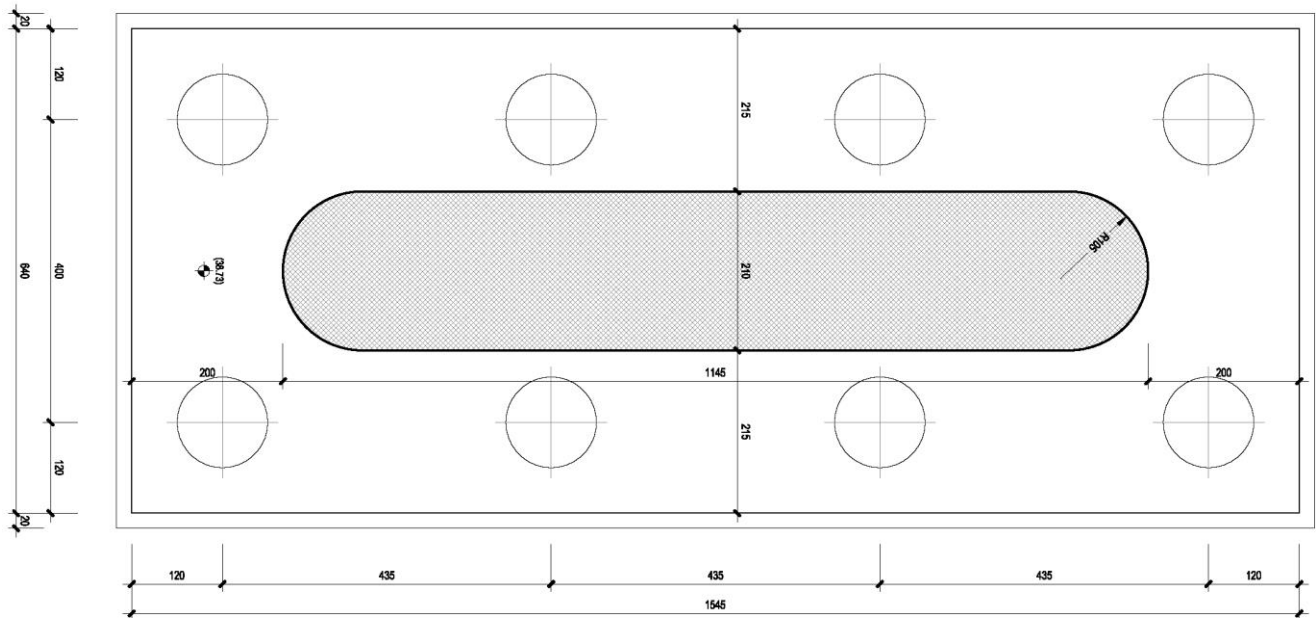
Plinto di fondazione e pali, vista in pianta - Sezione del fusto pila [m]
